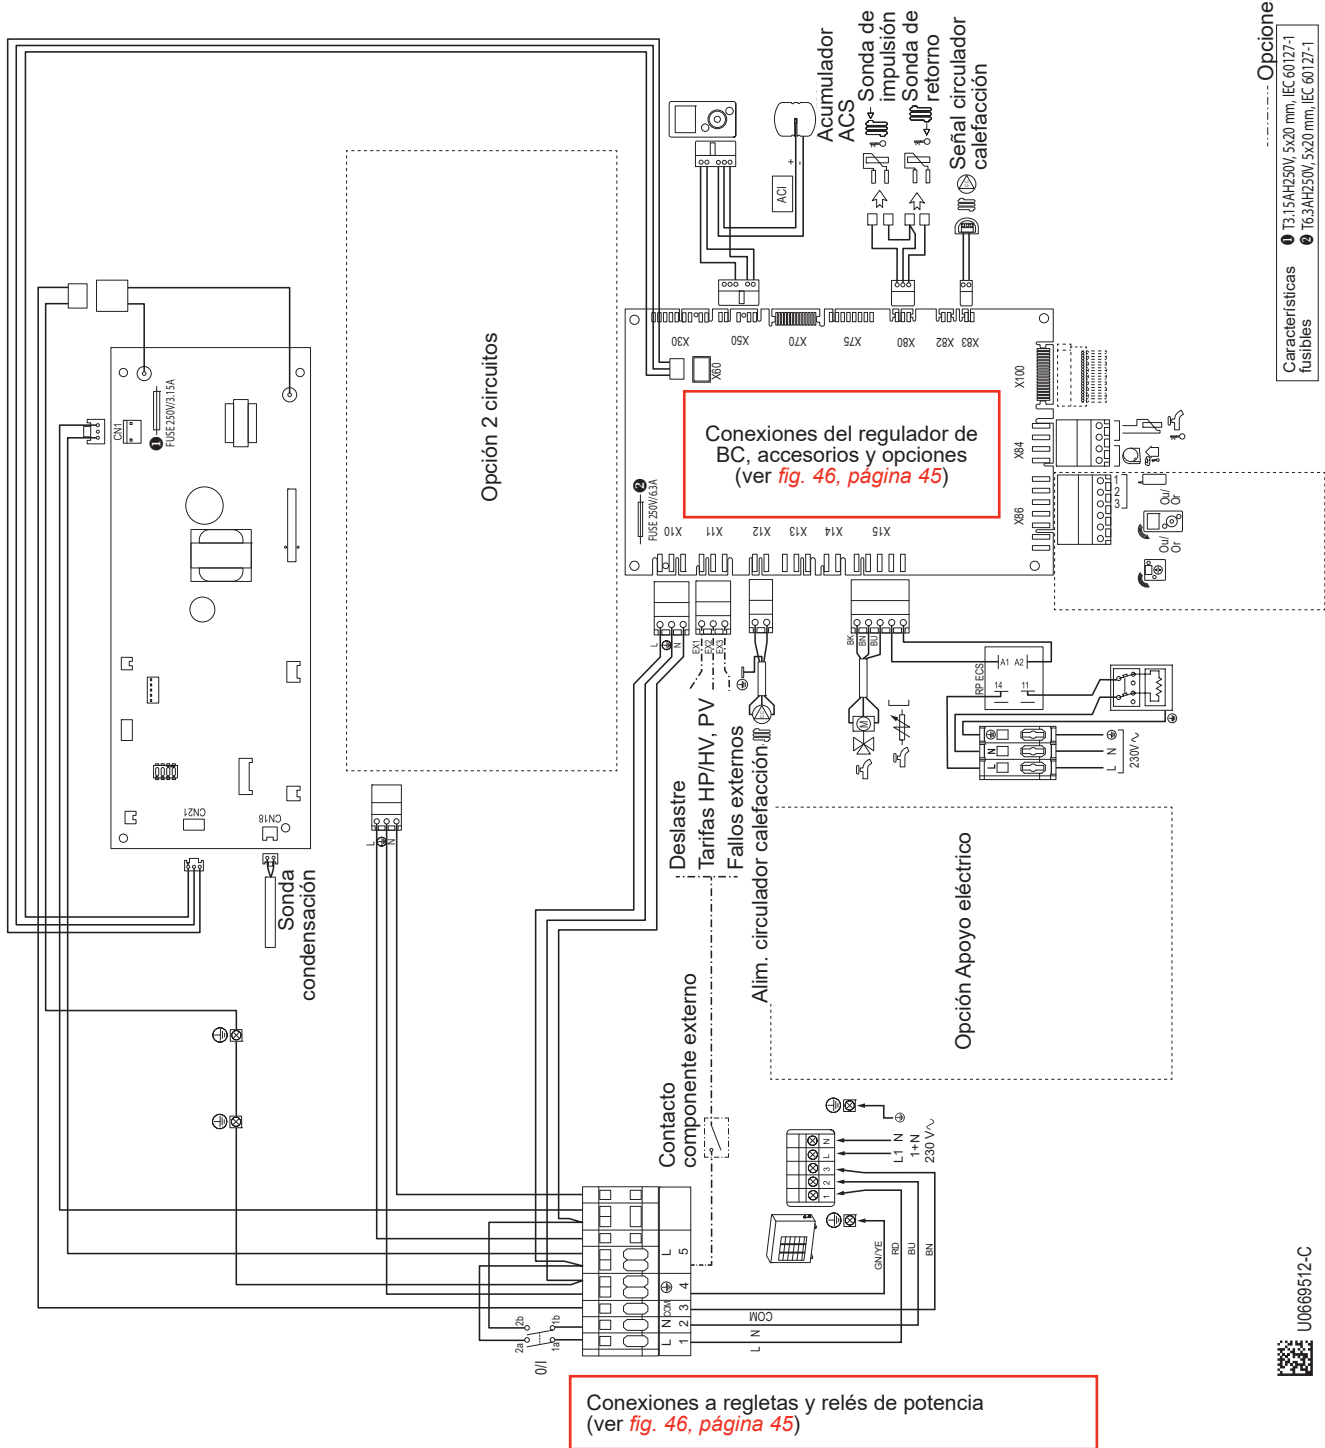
Cableado eléctrico del módulo hidráulico (salvo conexiones de instalador)
